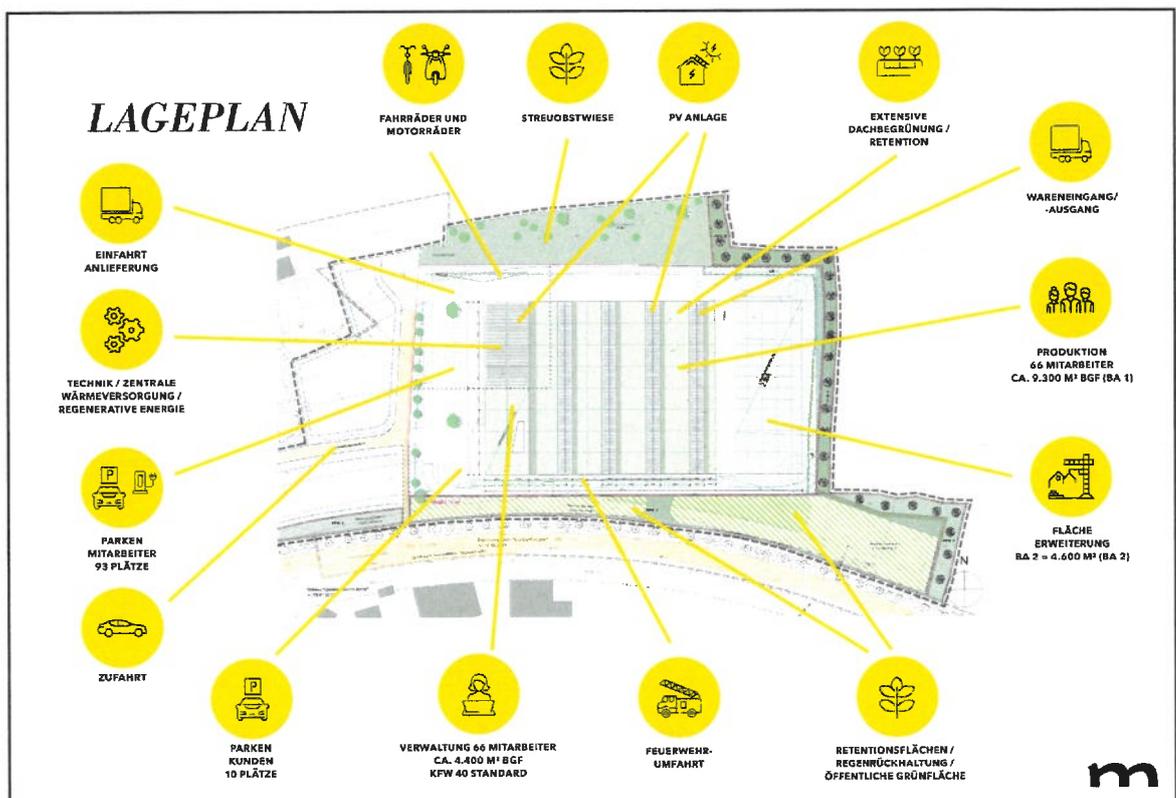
Planung Firmenflächen OSPA, unmaßstäblich [Quelle: Merz Objektbau]
